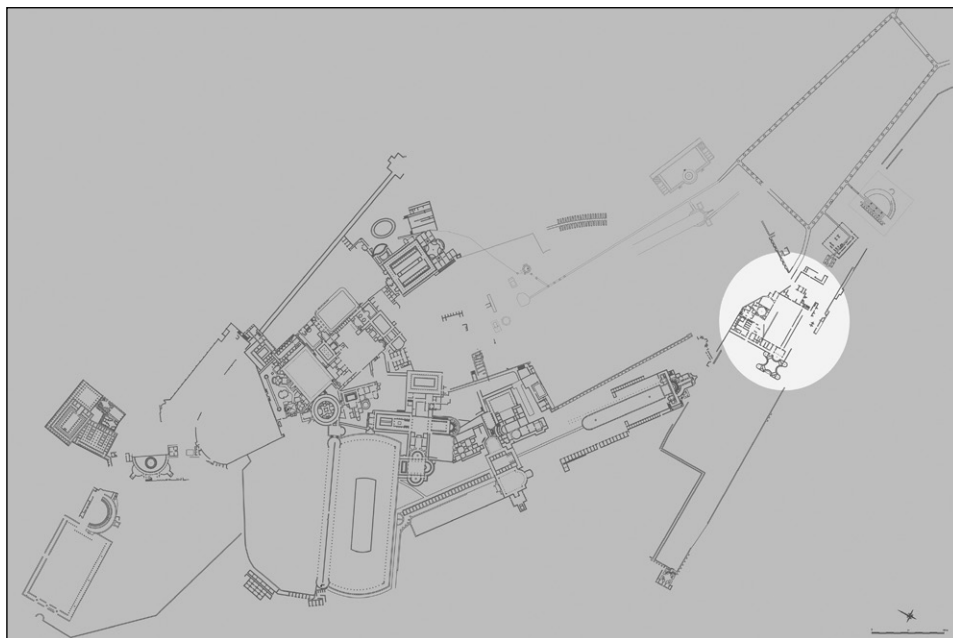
Villa Adriana, planimetria con in evidenza l’area della cd. Accademia (rilievo autore).
